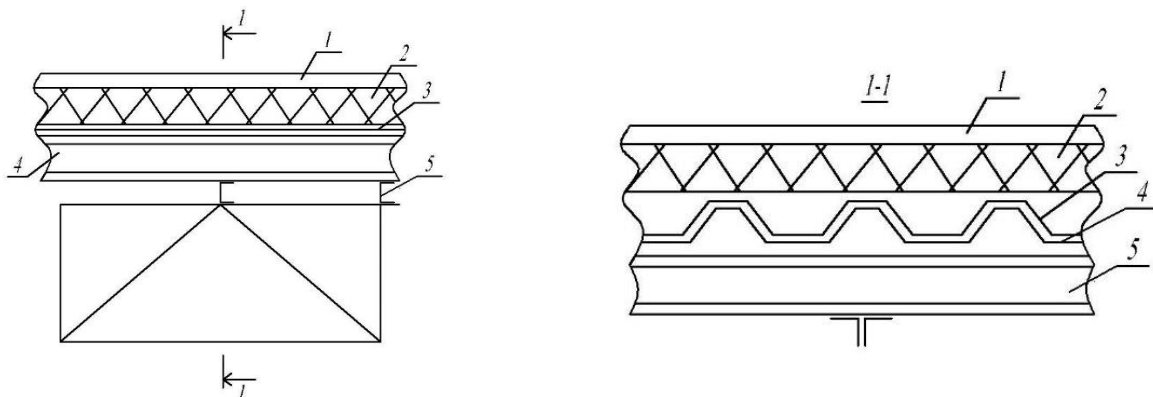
Конструкція покриття: 1 – гідроізоляційний килим (руберойд); 2 – утеплювач (напівжорсткі плити з пінопласту); 3 – пароізоляція (поліетиленова плівка); 4 – сталевий профнастил; 5 – прогон
